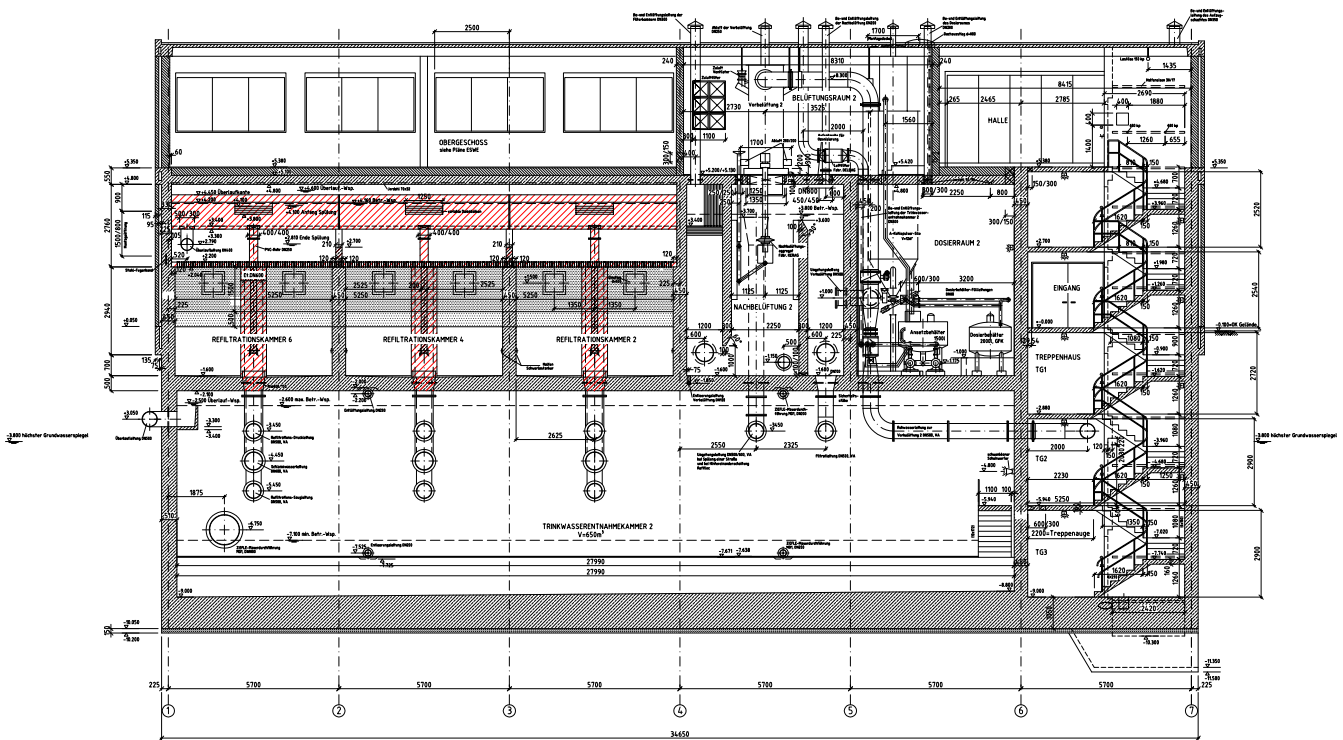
Ausschnitt aus dem Bestandsplan der Filter (rot markiert Rückbaumaßnahmen)
